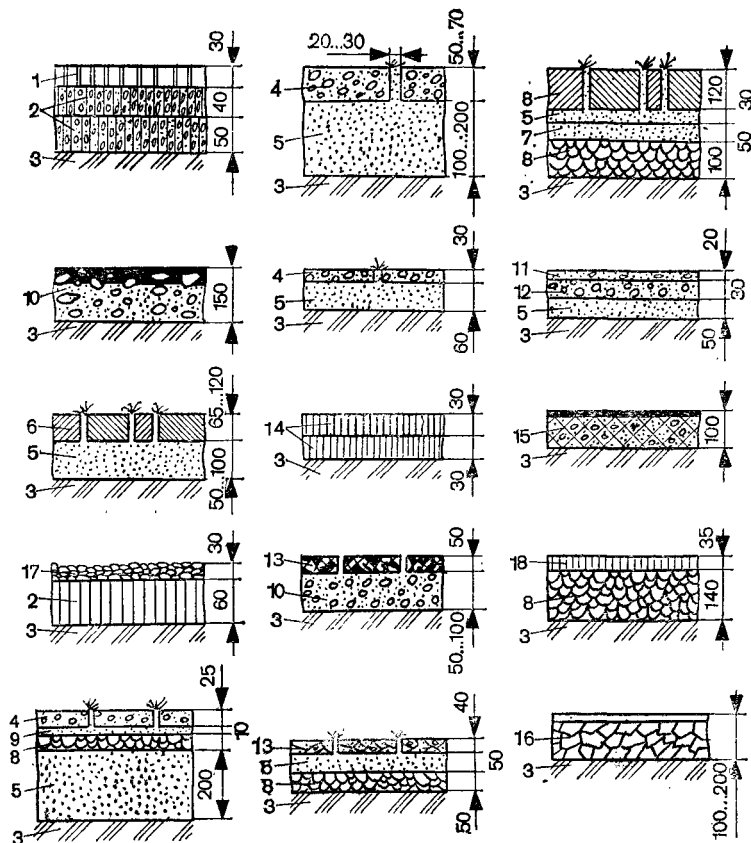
Конструкция некоторых покрытий дорожек и площадок:
